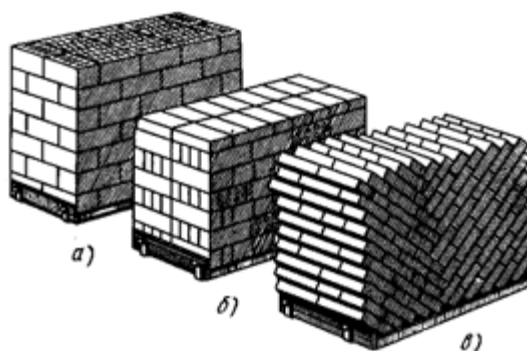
Укладка на поддонах кирпича с перевязкой
